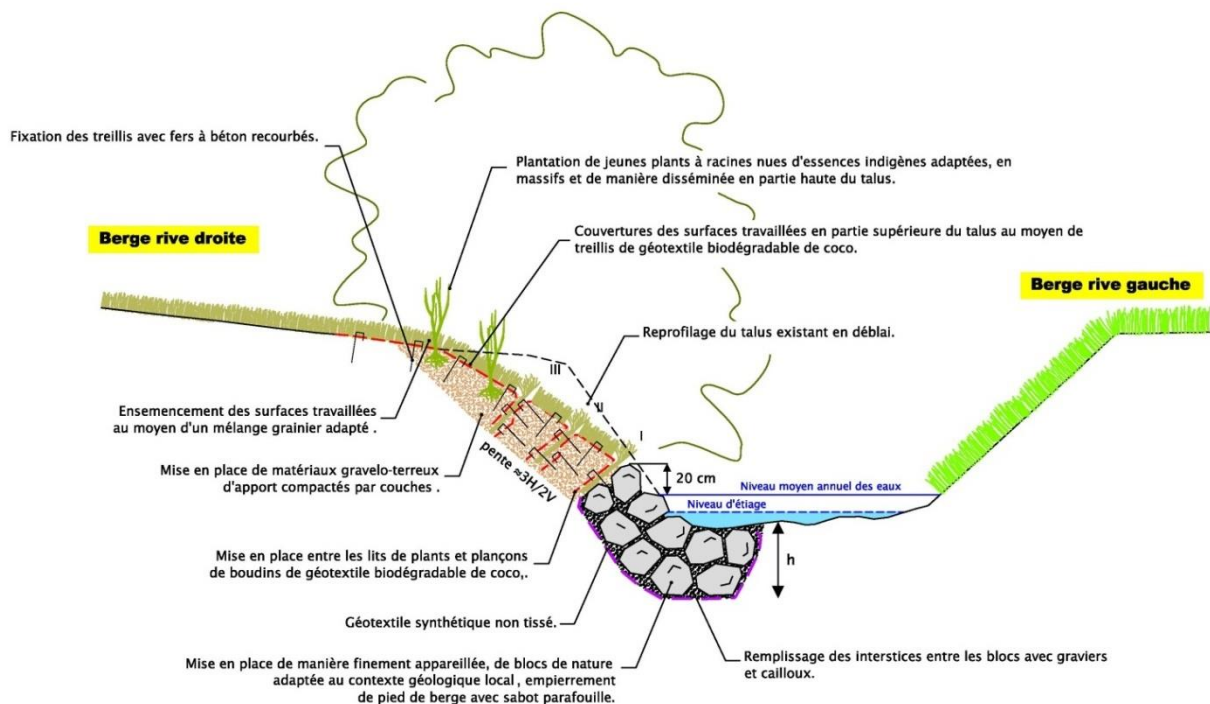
Protection de berge par enrochements et génie végétal (protection mixte) – Coupe type
